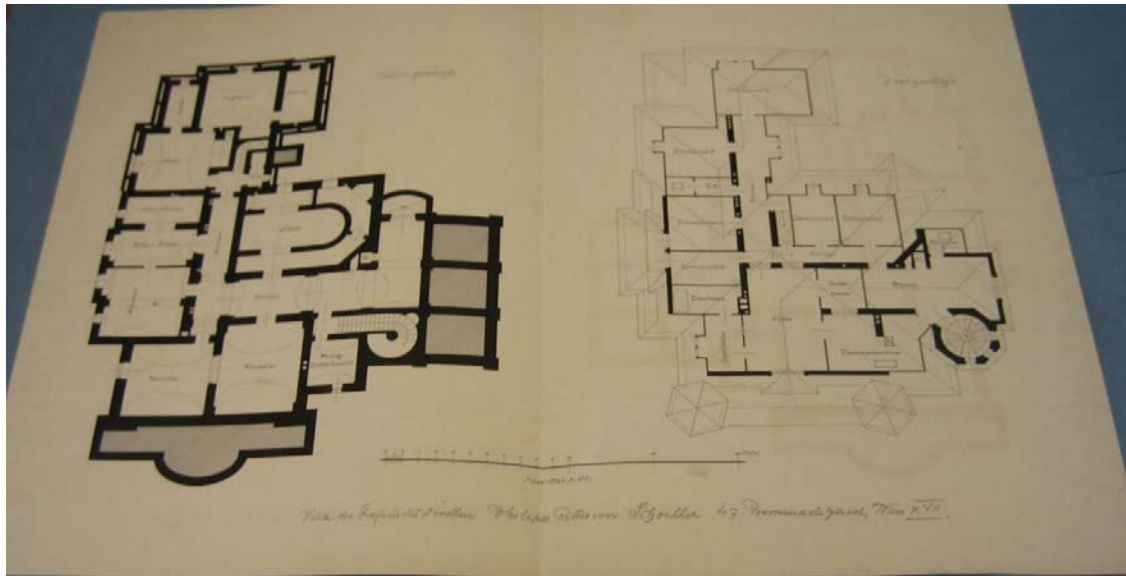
Grundriss Villa Schoeller Keller / Dachgeschoss
